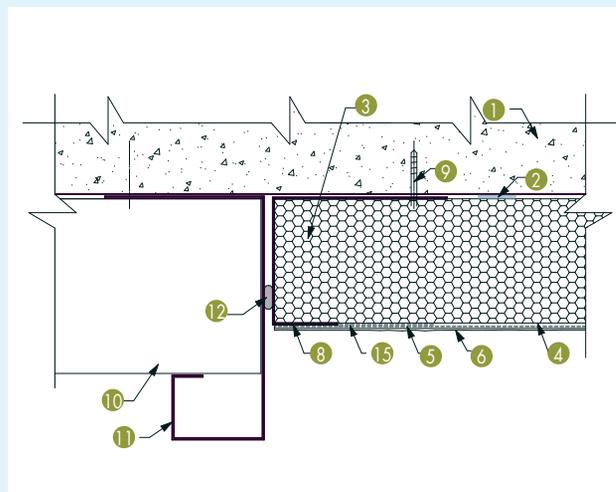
Raccordement avec d'autres systèmes d'isolation (coupe horizontale)
